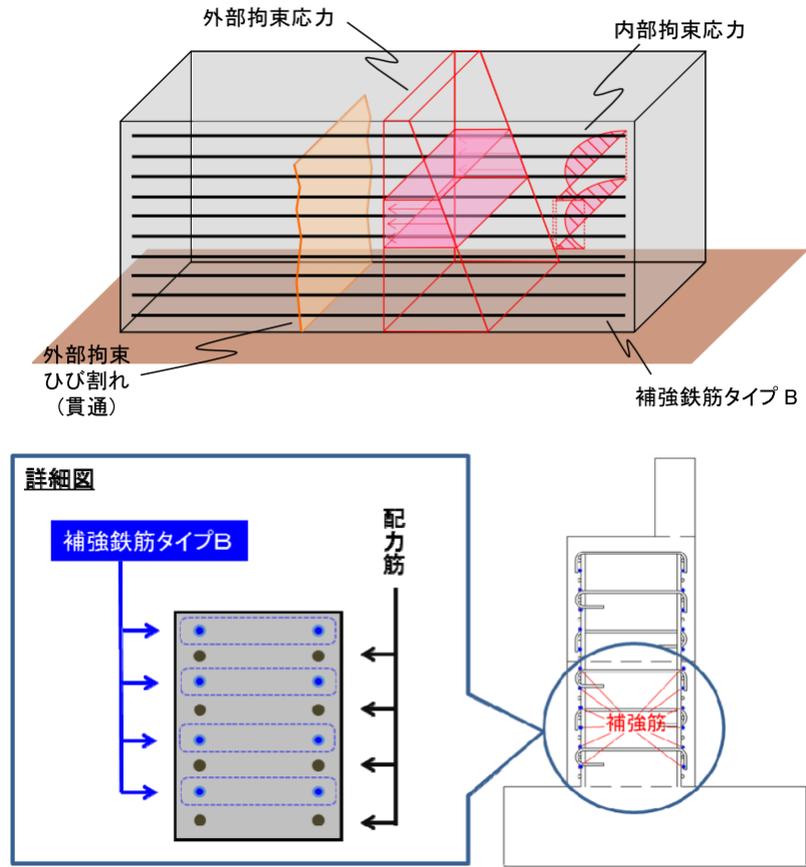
ひび割れ発生方向と抵抗鉄筋概要図 (補強鉄筋タイプ B) <sup>4)</sup> p.59
